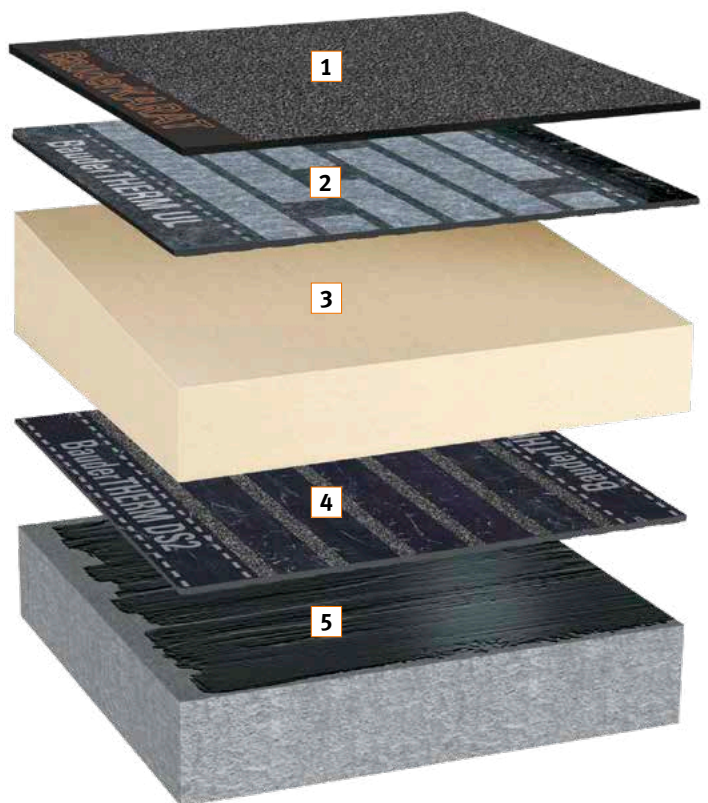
/1: Zweilagiges Bitumen-Abdichtungssystem auf Beton-Unterkonstruktion:
